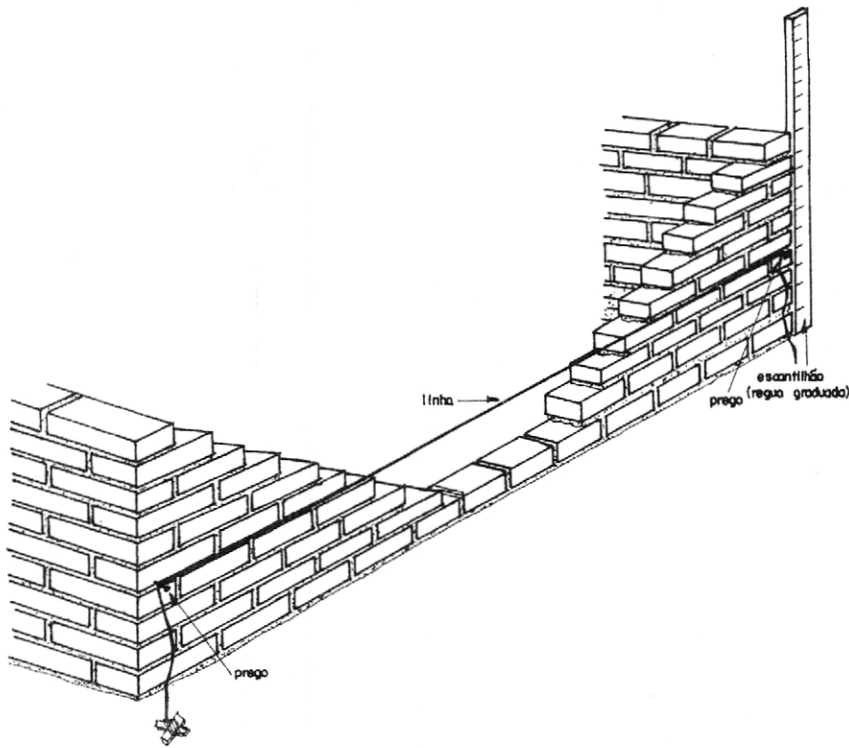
Detalhe do nivelamento da elevação da alvenaria.
